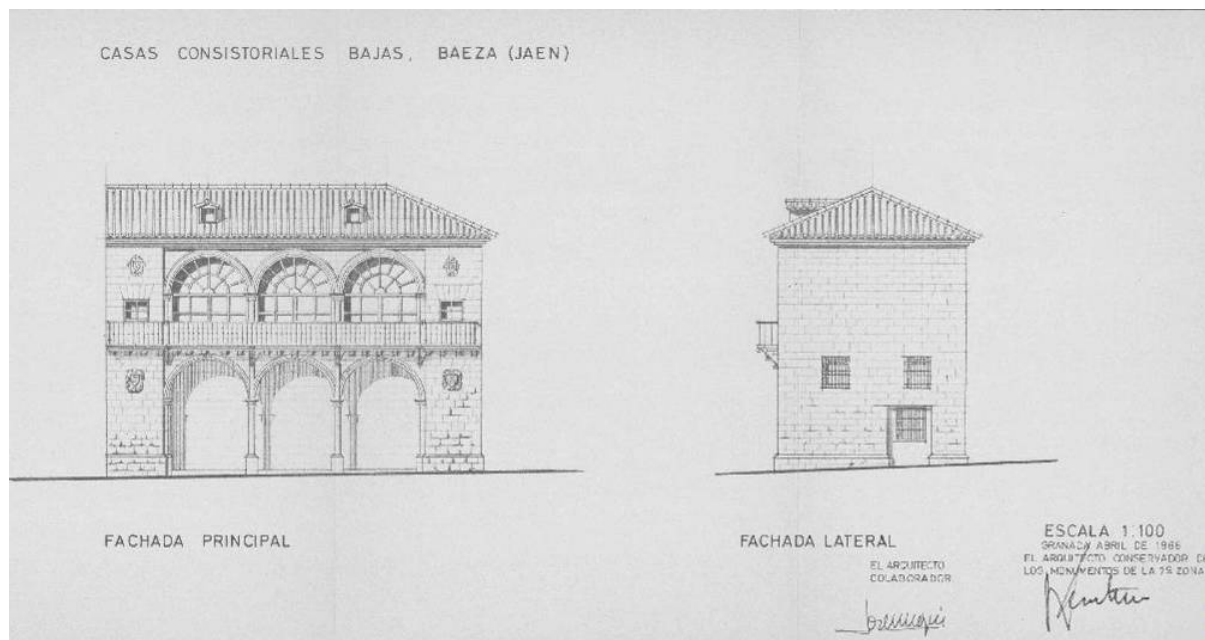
Alzados. Primera propuesta. 1966. *Proyecto de obras de consolidación y restauración en las Casas Consistoriales Bajas de Baeza*. AGA, IDD (3)115 caja 26/0211.
